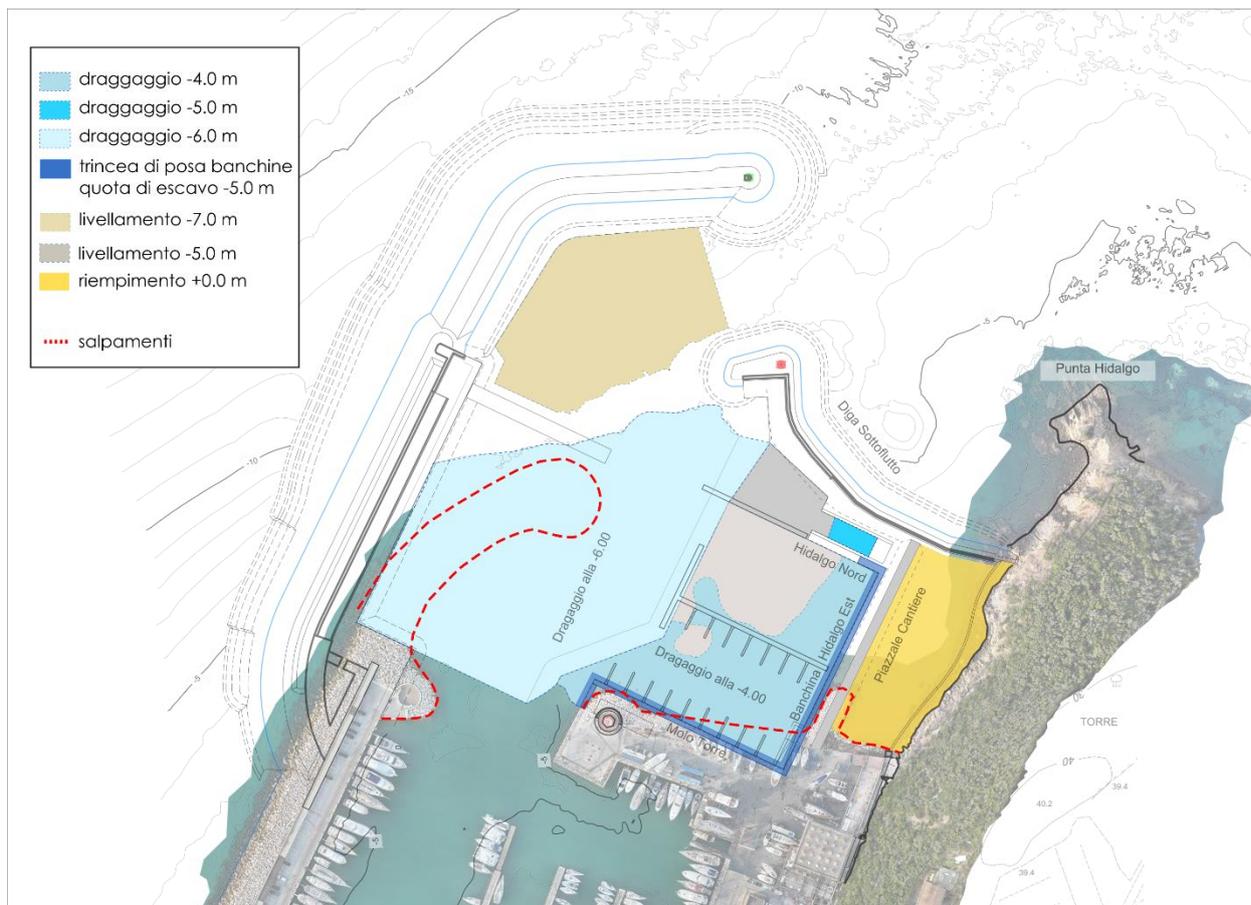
Stralcio planimetrico di progetto con indicazione degli specchi acquee oggetto di interventi di dragaggio e riempimento, localizzazione delle trincee di posa delle banchine. In rosso sono indicate le porzioni di opere foranee esistenti da salpare e ricollocare.
